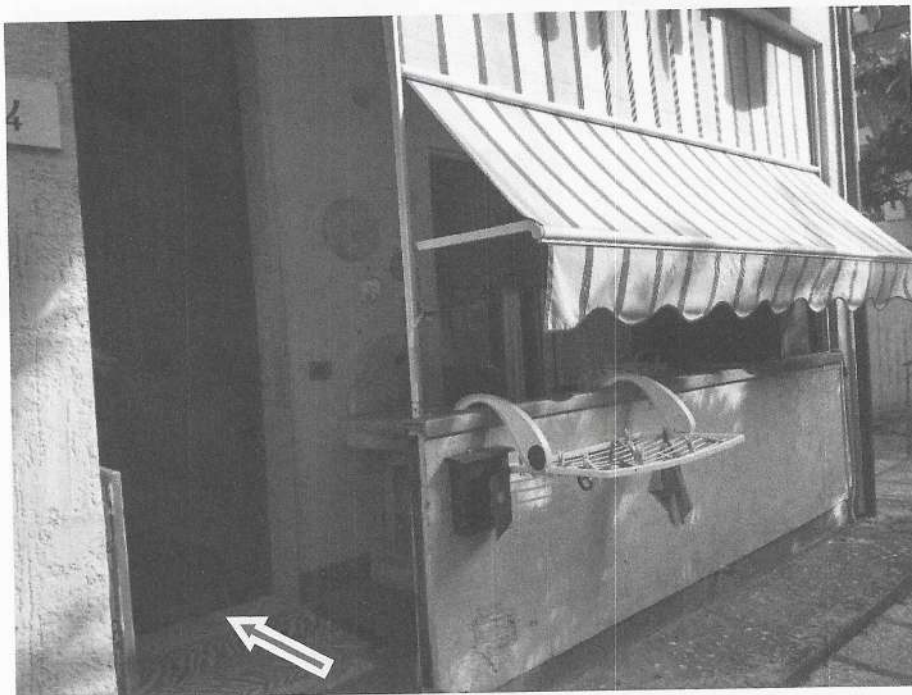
Vista della corte comune retrostante al piano terreno, del terrazzo e Dell'ingresso alla abitazione.
